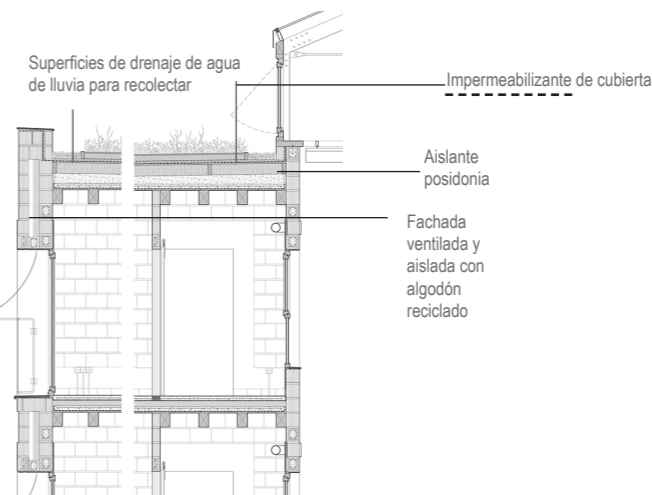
Protección de fachadas y cubiertas contra el agua.
